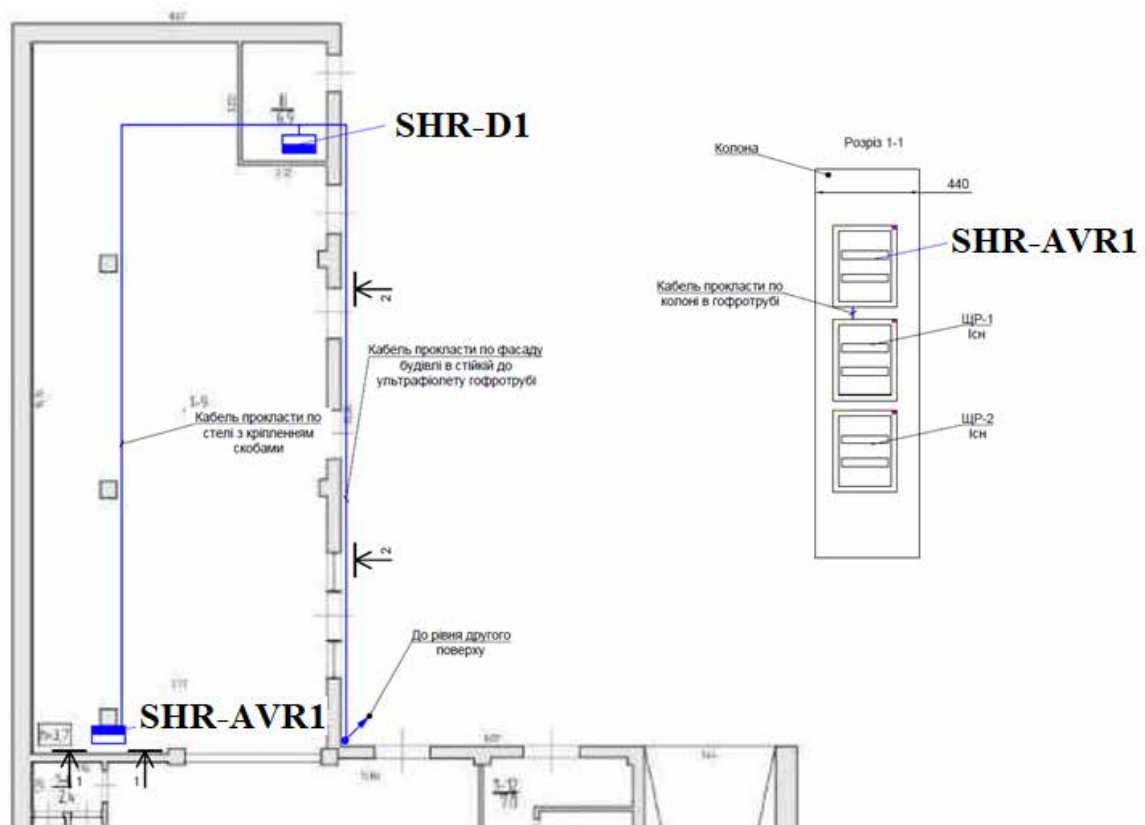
Схема монтажу кабеля електроживлення на першому поверсі
